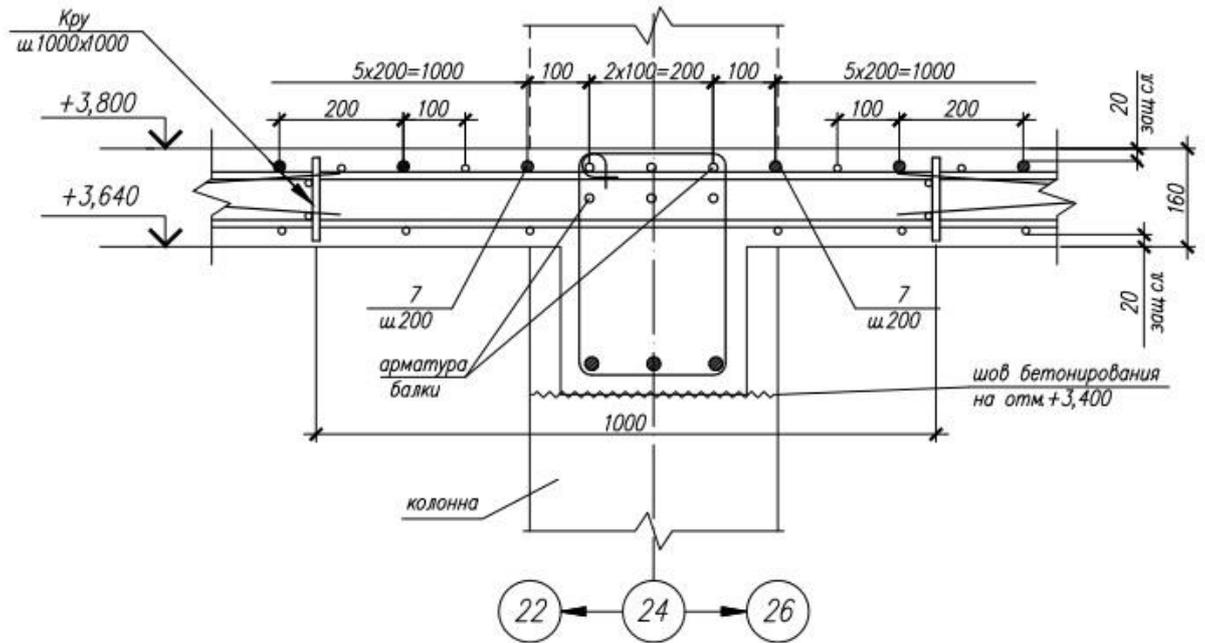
Схема армирования плиты из арматуры $\varnothing 10$
